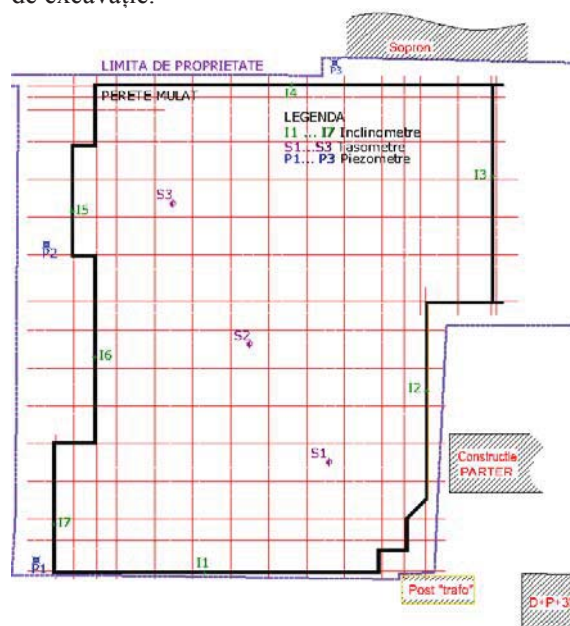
Amplasarea elementelor de monitorizare și a construcțiilor învecinate pe planul de incintă
